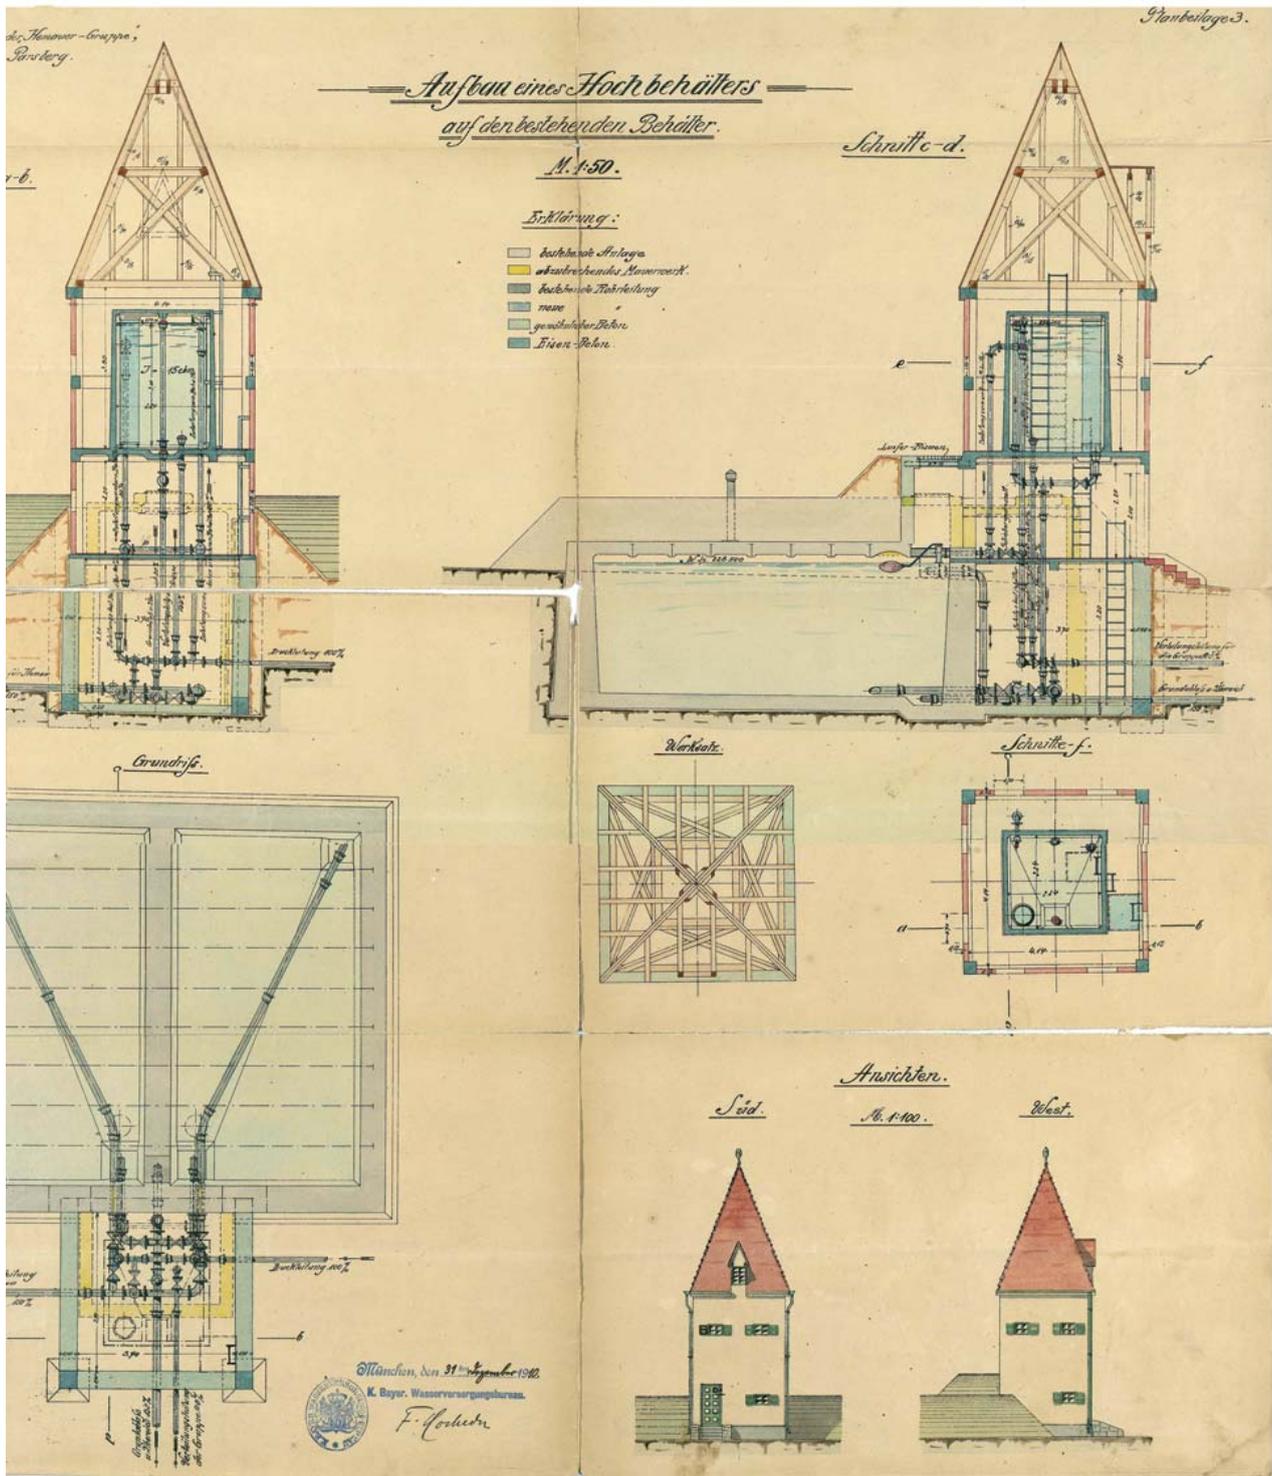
Plan für den Aufbau eines Hochbehälters aus dem Jahr 1910
